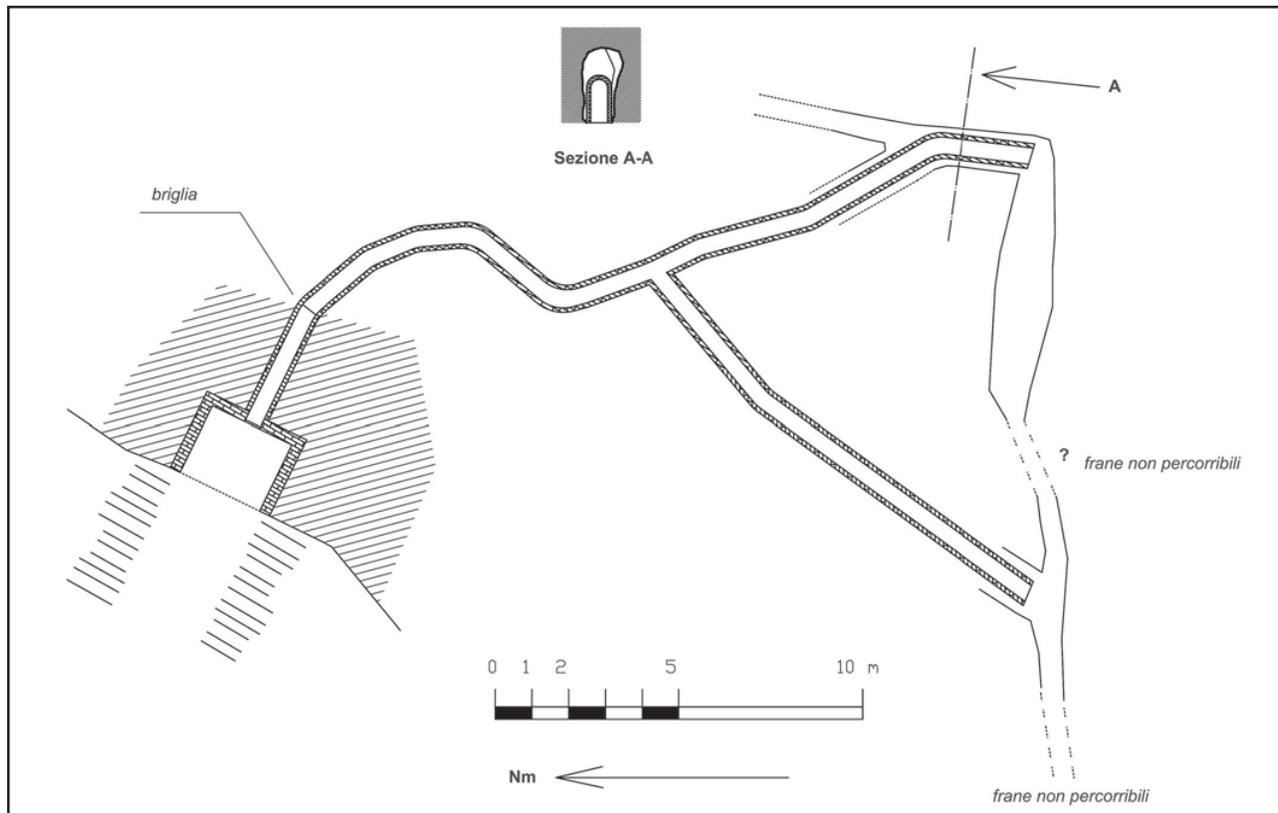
Pianta e sezione del cunicolo n. 2 "dei Verbiti" (esplorazione e rilievo CRS Egeria, 2008).
